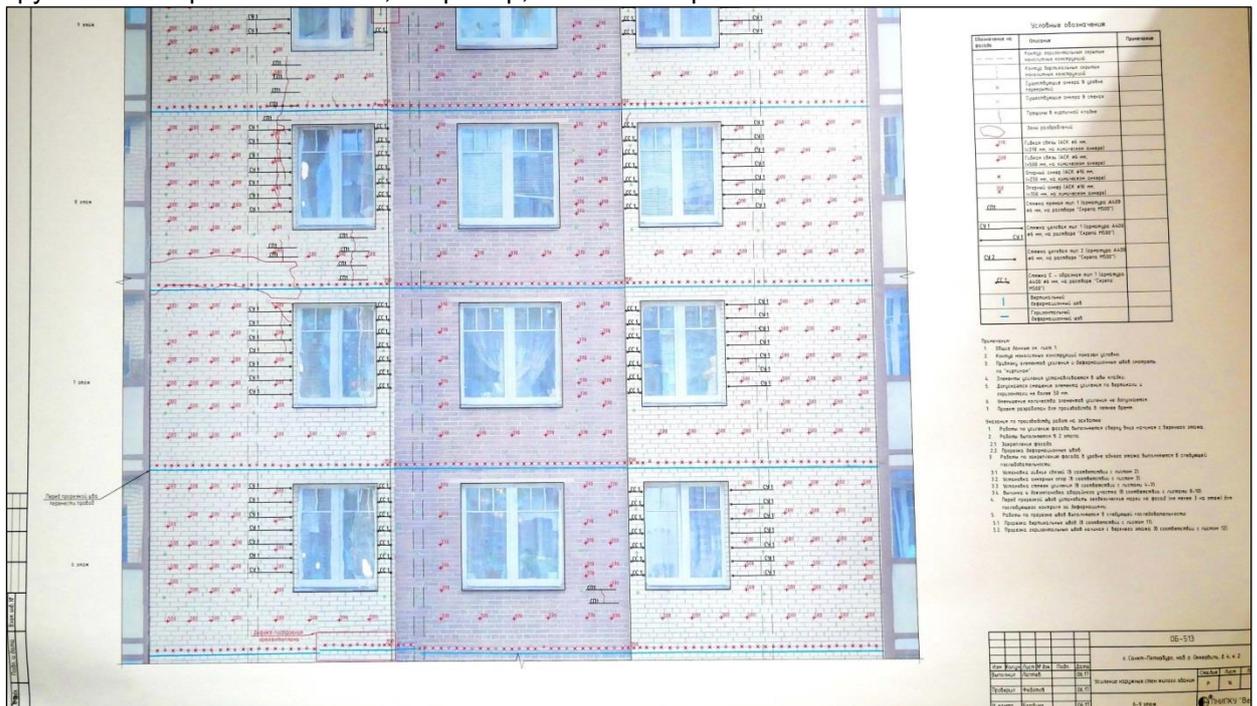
Лист из проекта усиления фасада жилого здания. Чертеж на основе ортофотоплана
